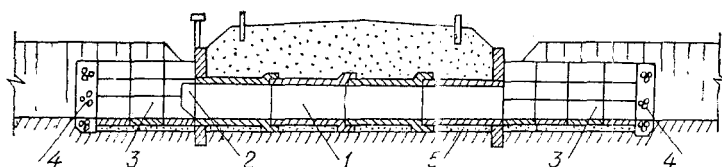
Шлюз-регулятор с переездом на осушительном канале:
